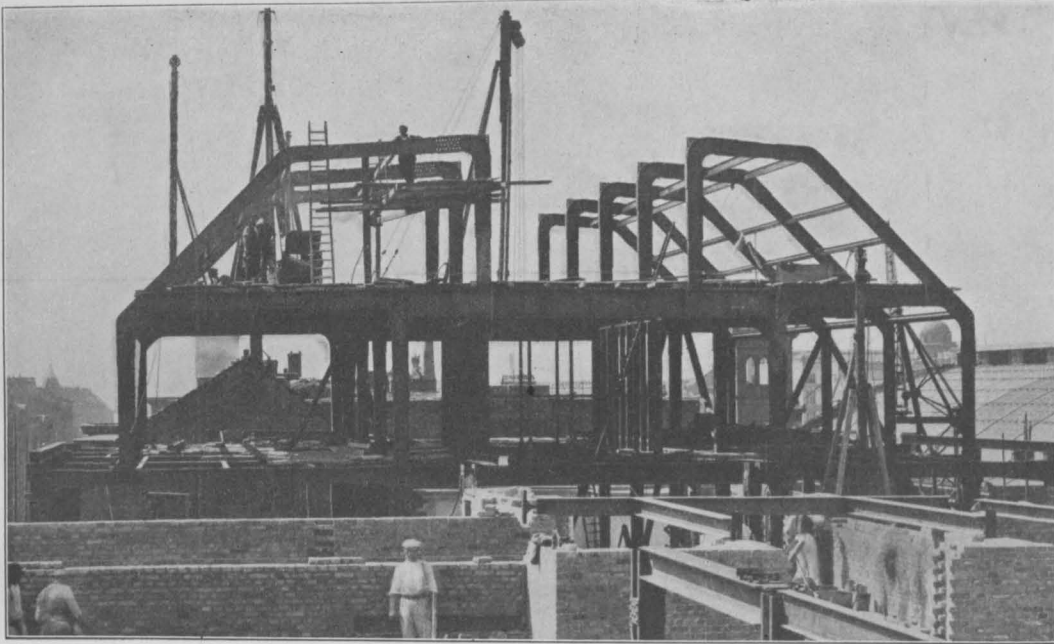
Montage der Eisenkonstruktion des Daches über dem Langbau.
